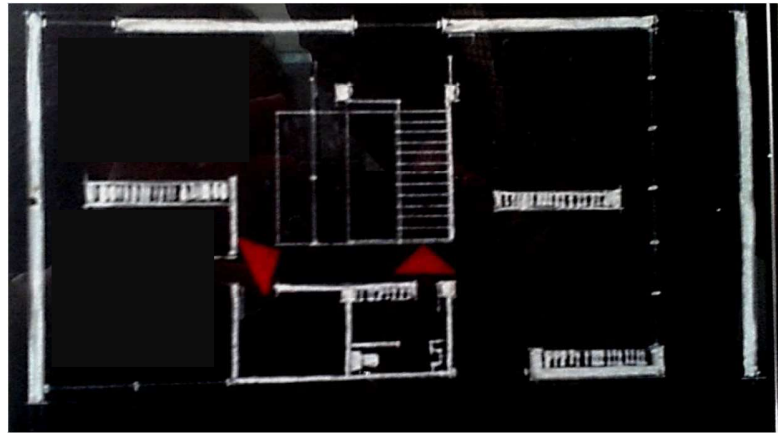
Boceto de planta alta, despacho de Jorge Montes
